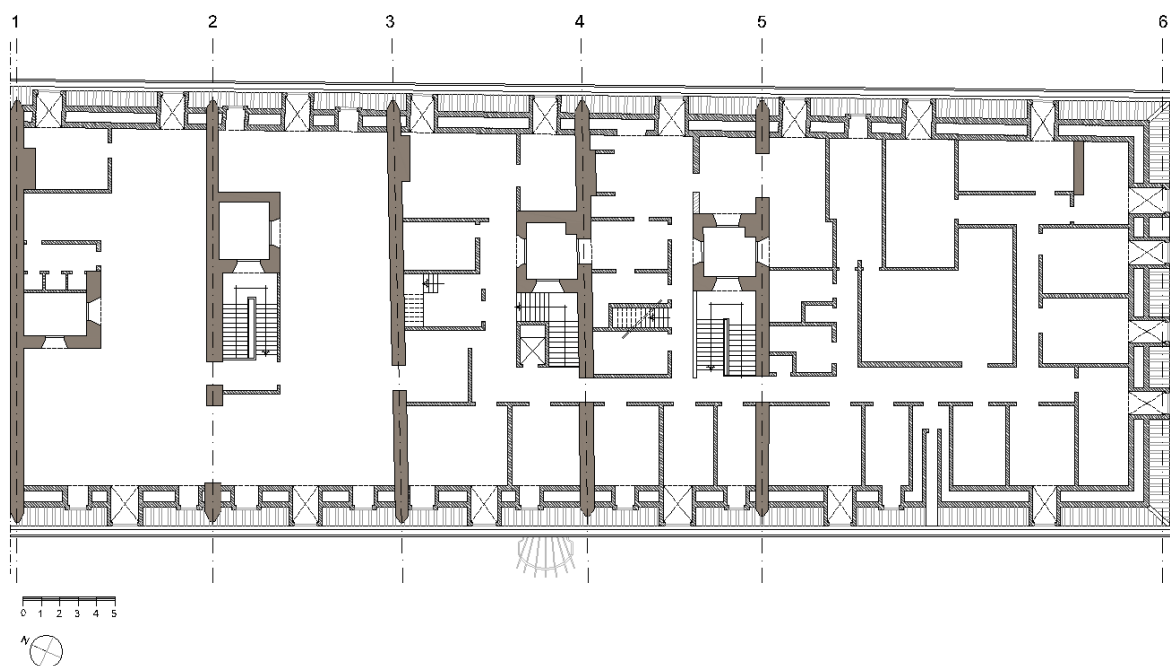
Planta do Piso Águas Furtadas – (Levantamento do Existente)
